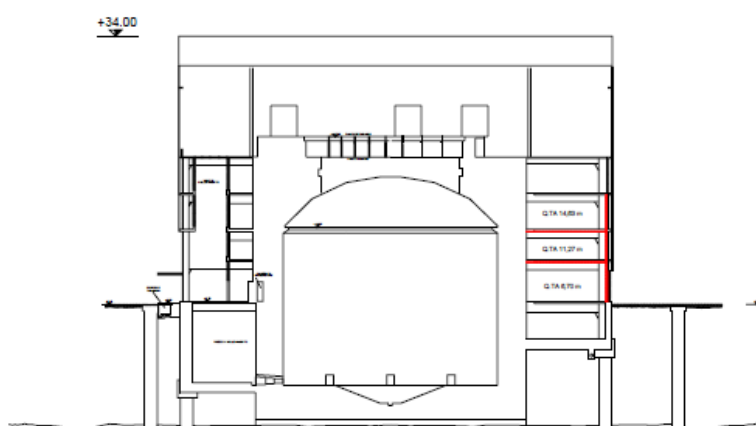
Planimetria Edificio Reattore quota 14,63 m s.l.m.m - strutture portanti di rinforzo strutturale
